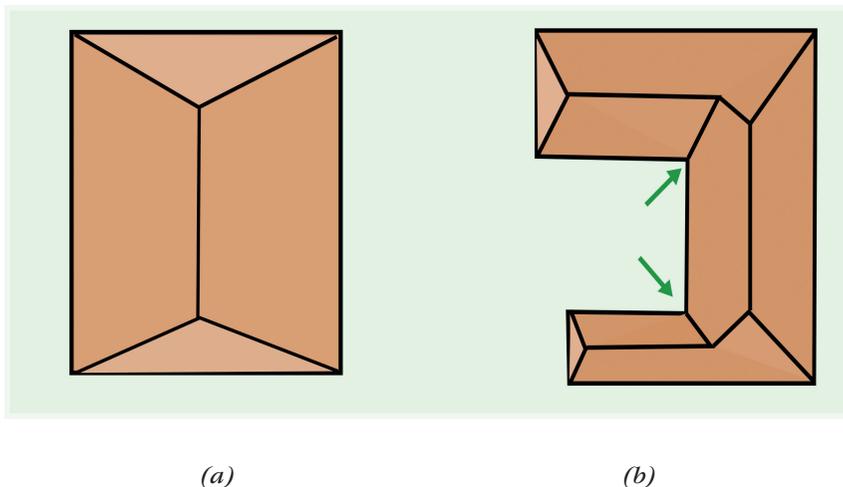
Simplificação da planta (a) e minimização dos cantos reentrantes (b) na geometria da habitação.
